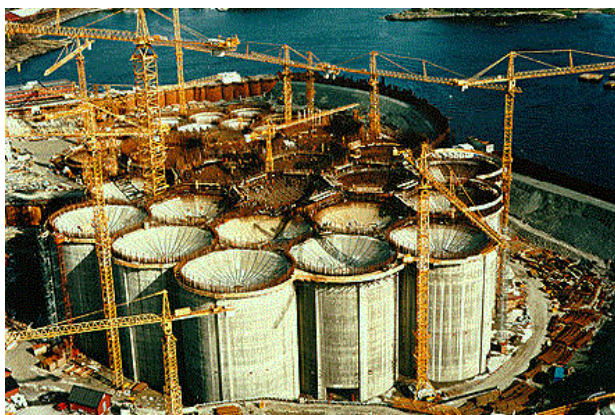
Cimentación de una plataforma de concreto apoyada por gravedad
